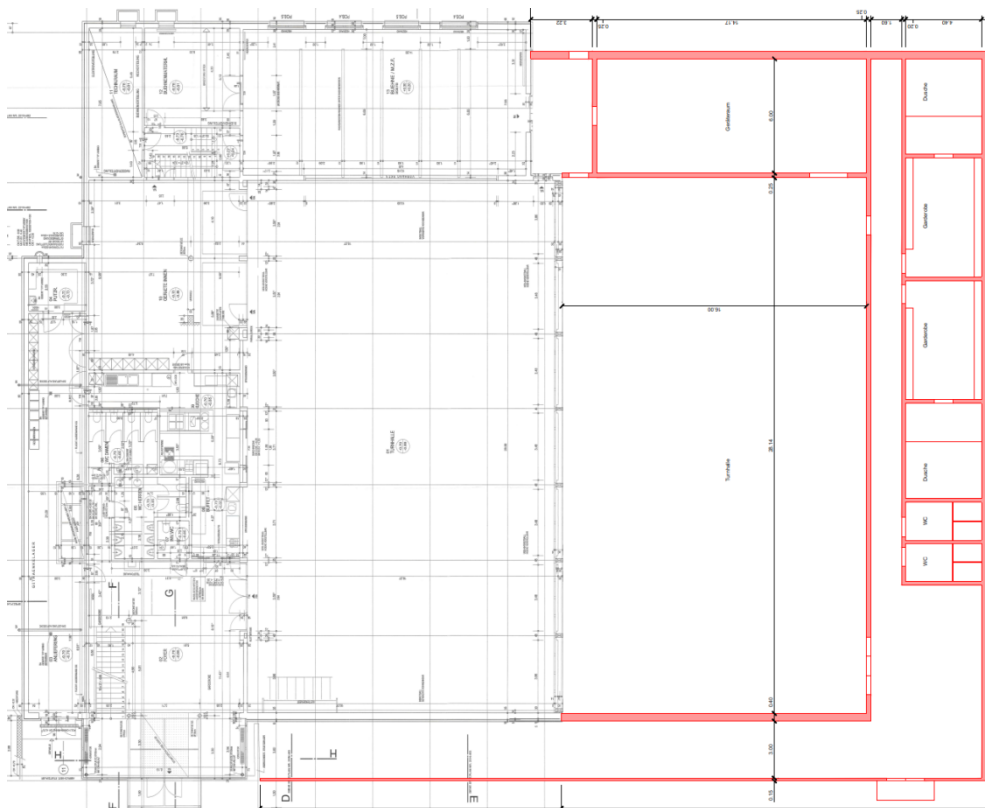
Grundrisssskizze Erweiterung
